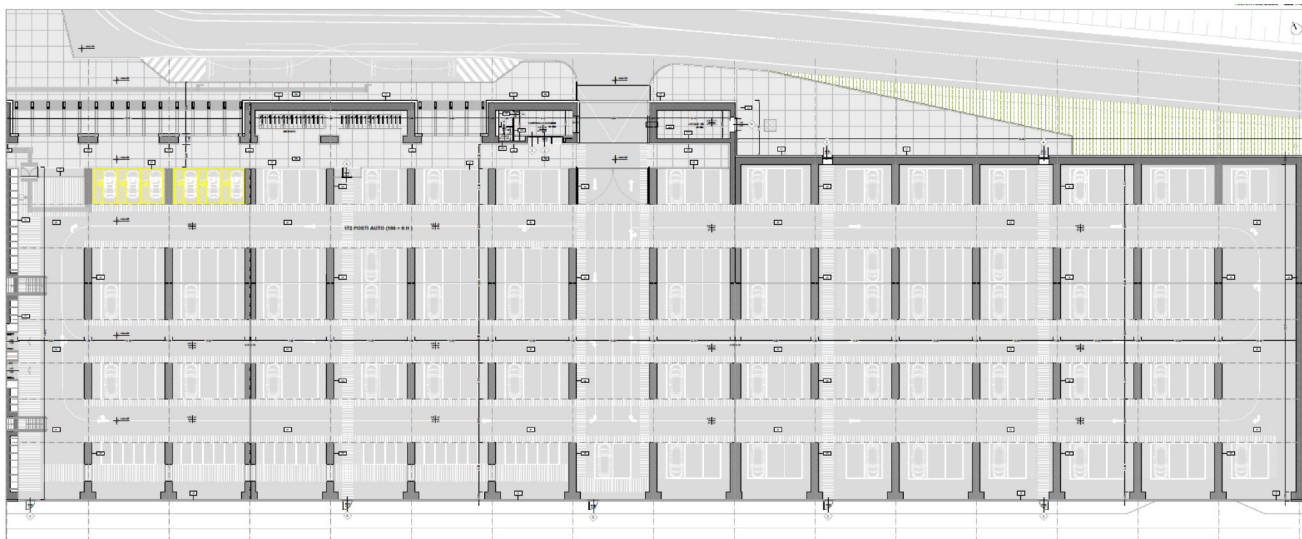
Stazione di Nuova Enna: Pianta quota parcheggio
